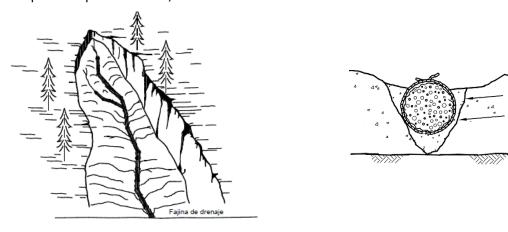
Colocación de fajina de drenaje con suelo en zanja.
